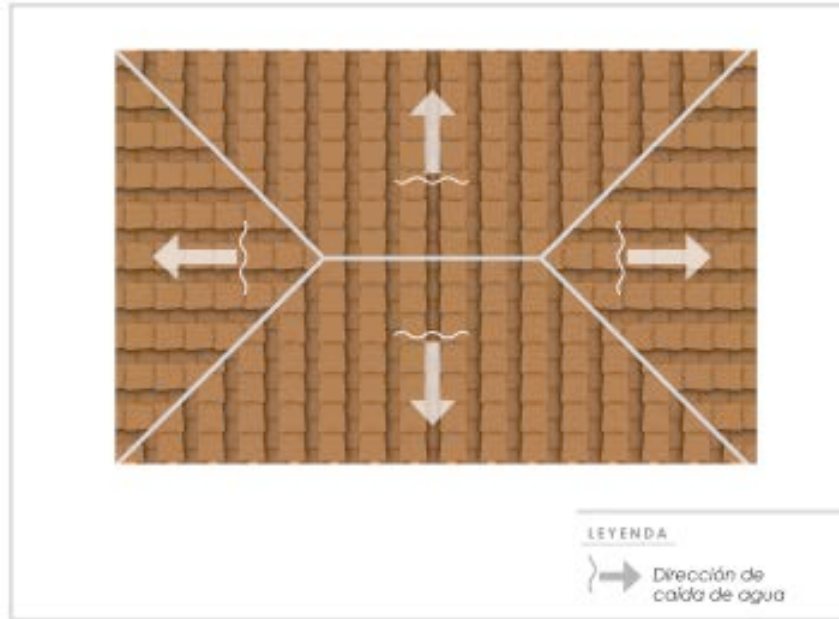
Tipo 2. Esquema de planta rectangular. Techo a cuatro aguas.
